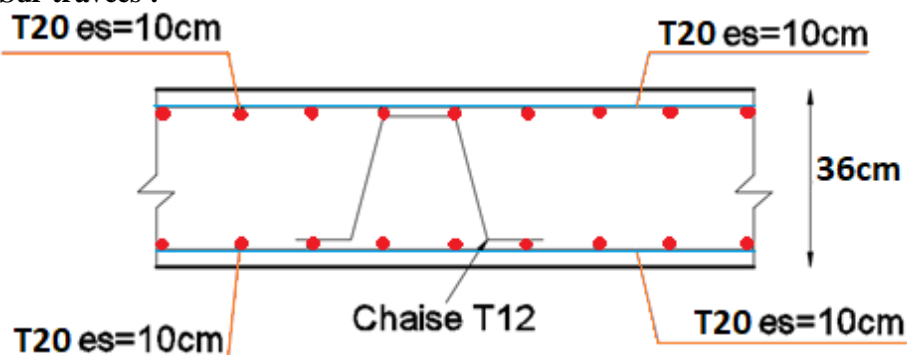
Schéma de ferrailage de la dalle du radier sur travée.
